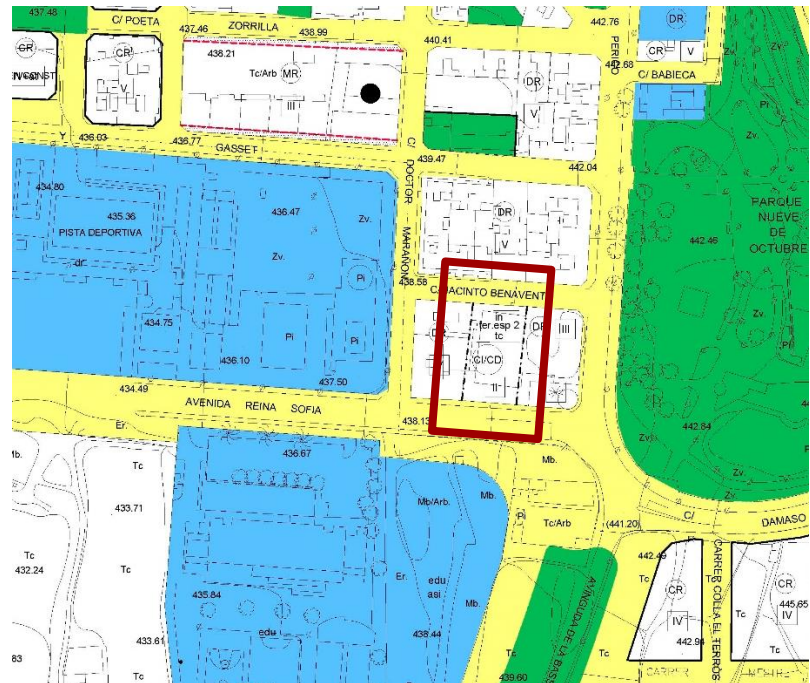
Nueva ordenación pormenorizada. Ámbito modificación
